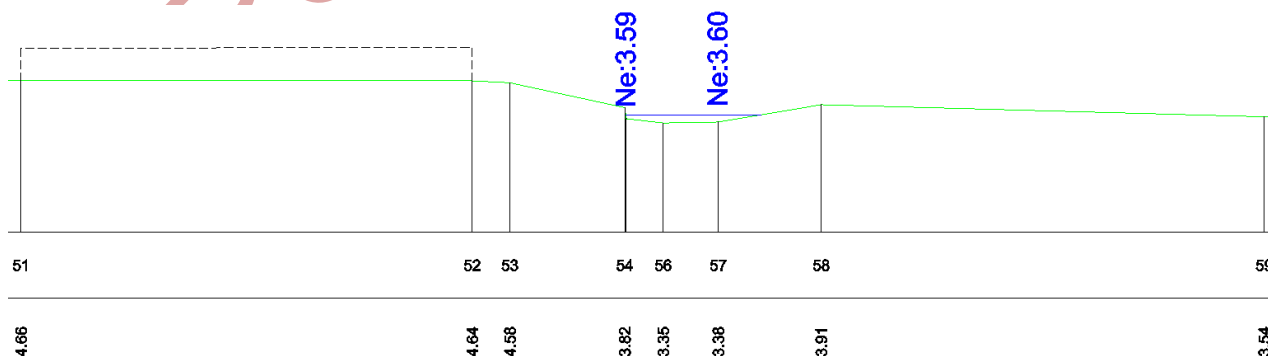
Profil en long au niveau de l'ouvrage de franchissement de la voie ferrée (OH4)
